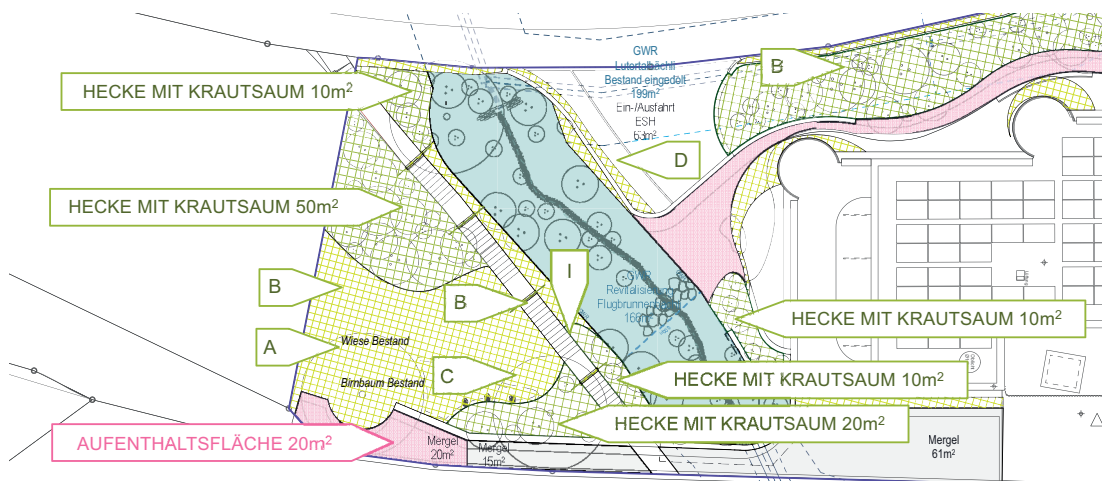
Ersatzmassnahmenplan Hecken Stand 2. öffentliche Auflage (November 2025) mit Änderungen gegenüber der Version Beschlussfassung
